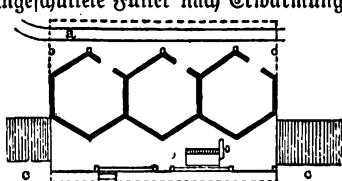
Grundriß. a Füllbahn, b Hackelmaschine, c Bösung.
